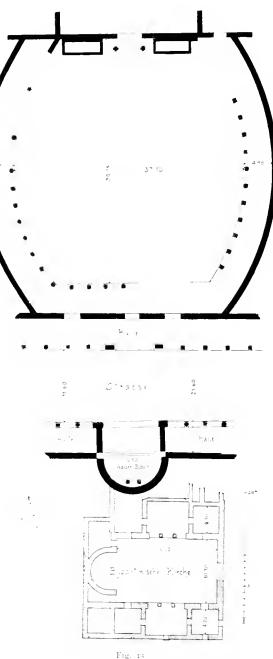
Grundriss der Arkadiane bei der Straßenkreuzung
